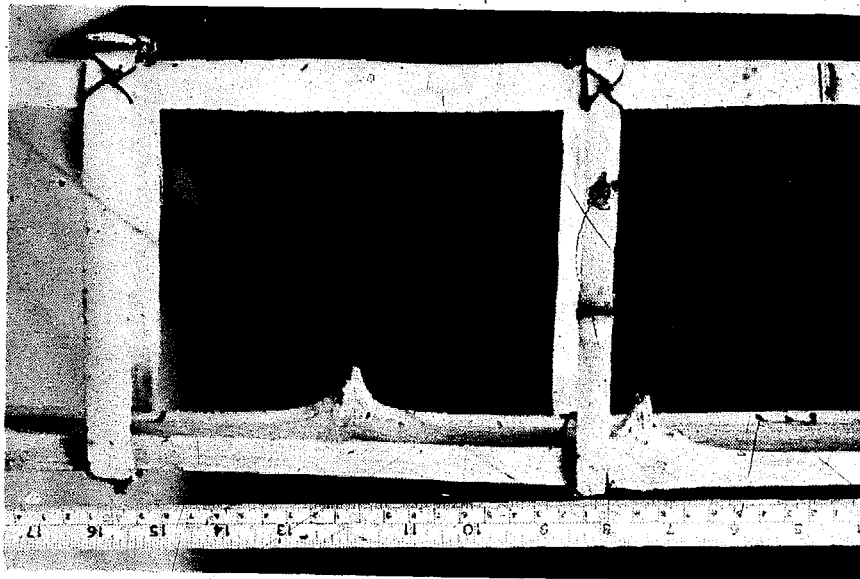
Armadura con refuerzo de tablillas colocadas horizontalmente.
